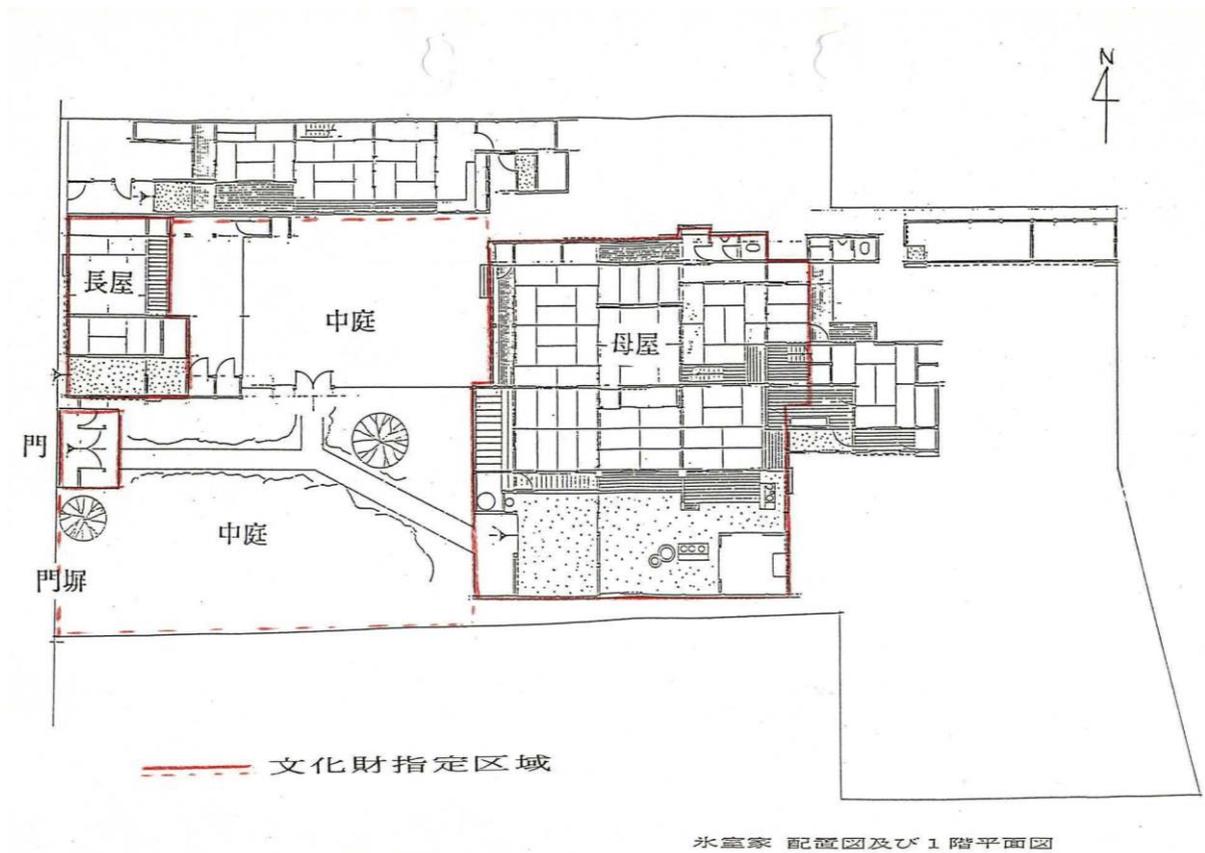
「氷室家 配置図及び1階平面図」 赤線内が文化財指定範囲
